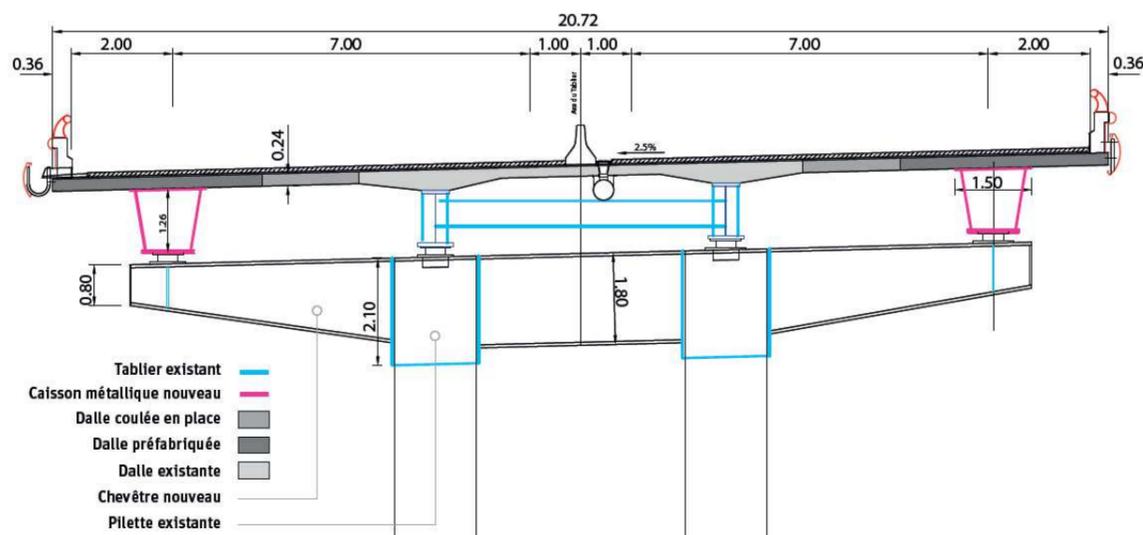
Variante 2 – Coupe sur ouvrage (source CEREMA)
